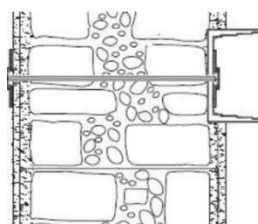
Representação esquemática de novas aberturas em paredes reforçadas para apoio de novos pavimentos [14]
